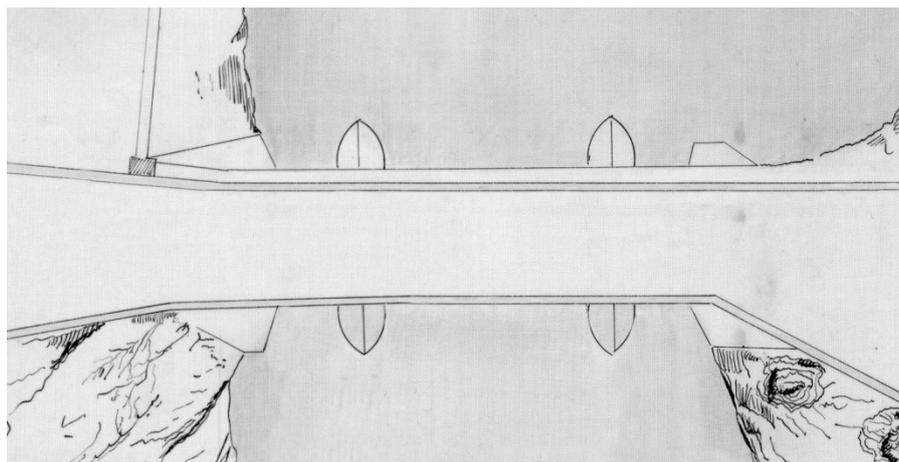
Pianta del secondo ponte delle Teste desunta da un progetto di epoca successiva.
